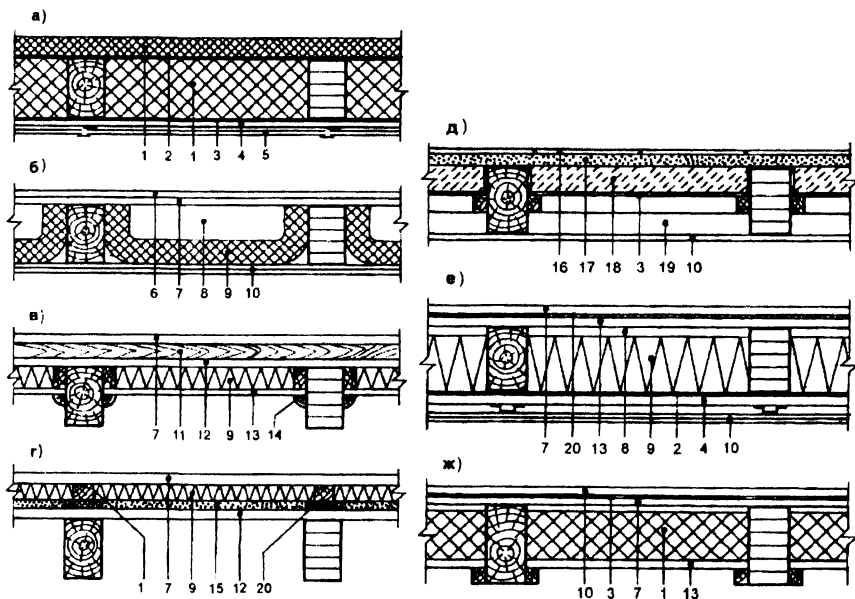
Варианты перекрытий с цельными и клеёными деревянными балками
